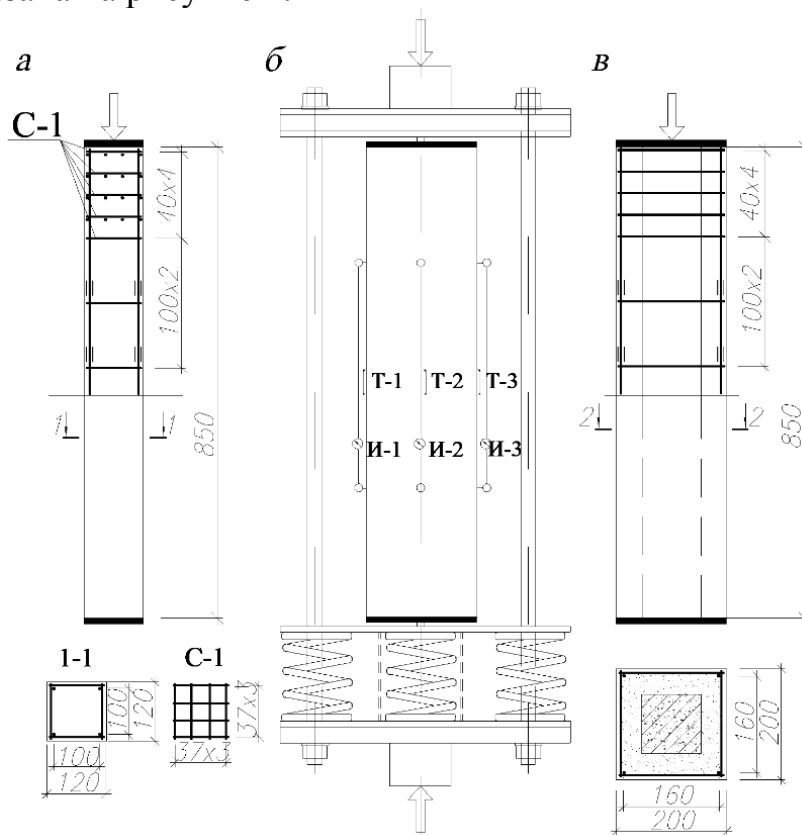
Экспериментальное исследование сжатых железобетонных элементов, усиленных под нагрузкой: а) конструкция опытных элементов; б) схема установки для длительного нагружения при усилении и испытании с расположением приборов; в) конструкция опытных элементов после усиления
